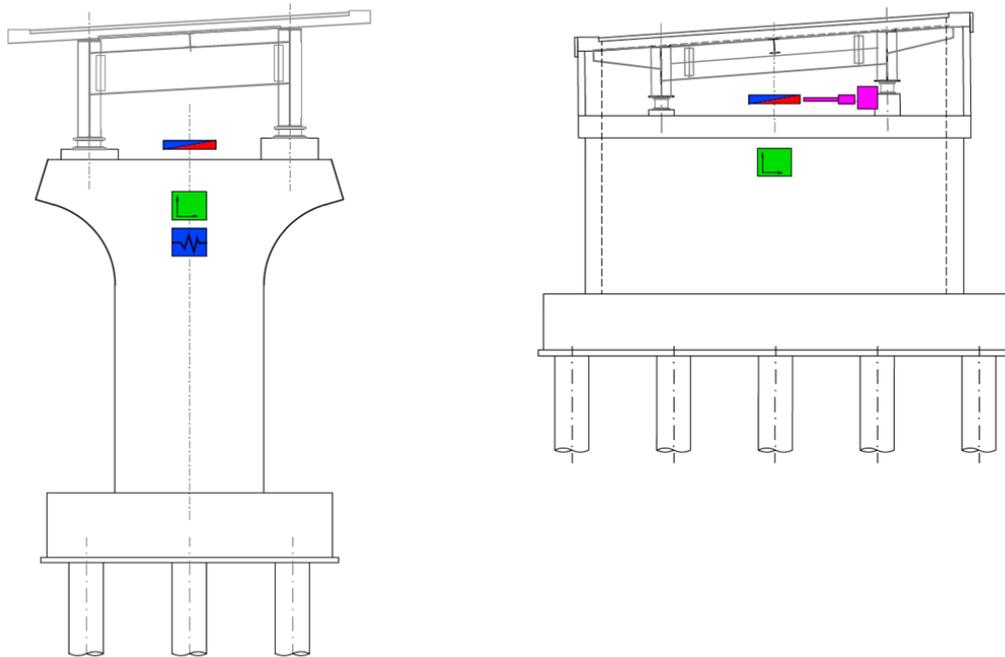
Schema posizionamento strumentazioni pila viadotti (sx) e spalla (dx)
